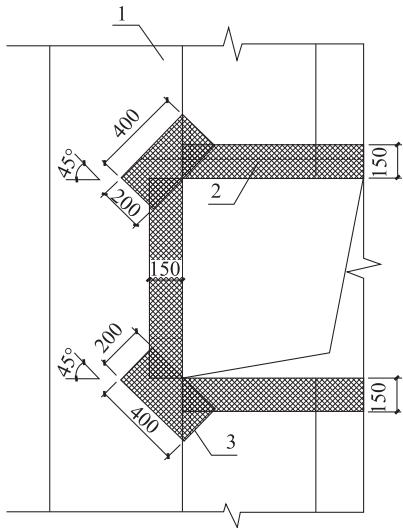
门窗洞口周边耐碱玻纤网布设置示意图
